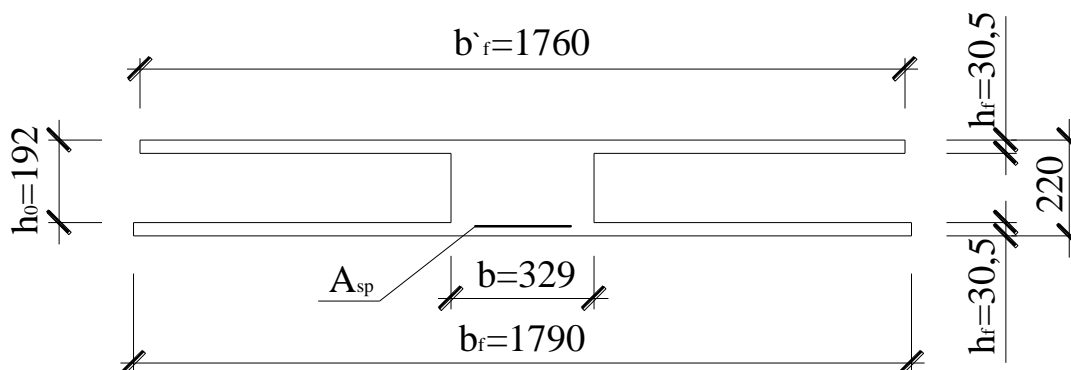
Переріз багатопустотної плити перекриття замінюємо еквівалент двотавровим
